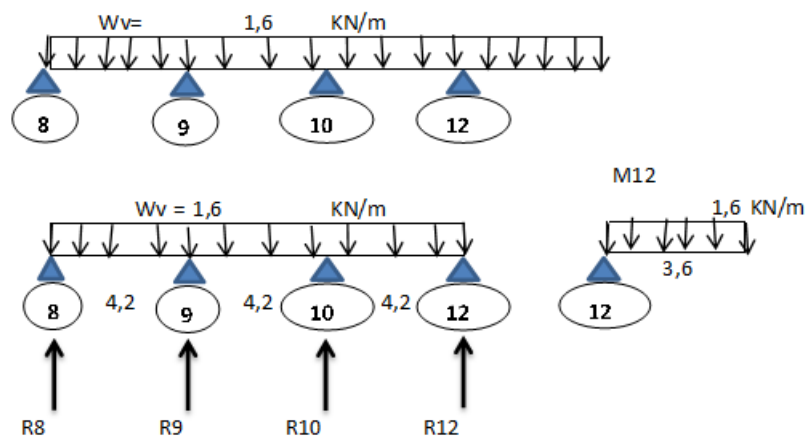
Modelo matemático de viguetas tipo 1, carga viva actuante
